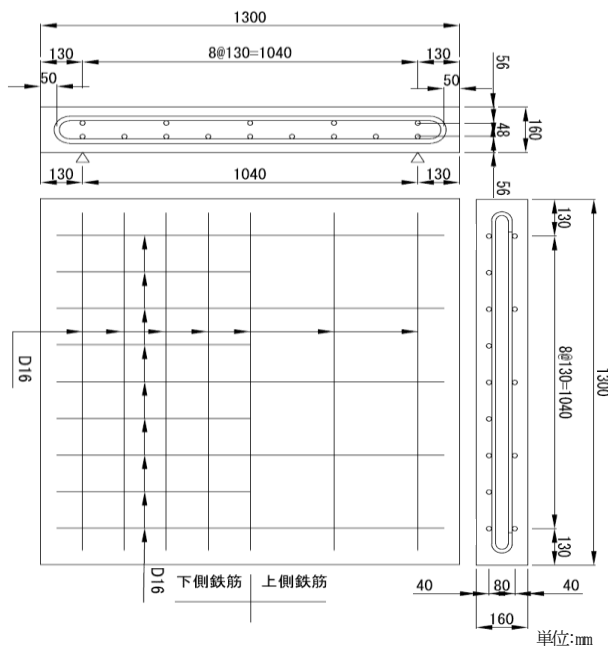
スラブ供試体の形状寸法、配筋試験概要
